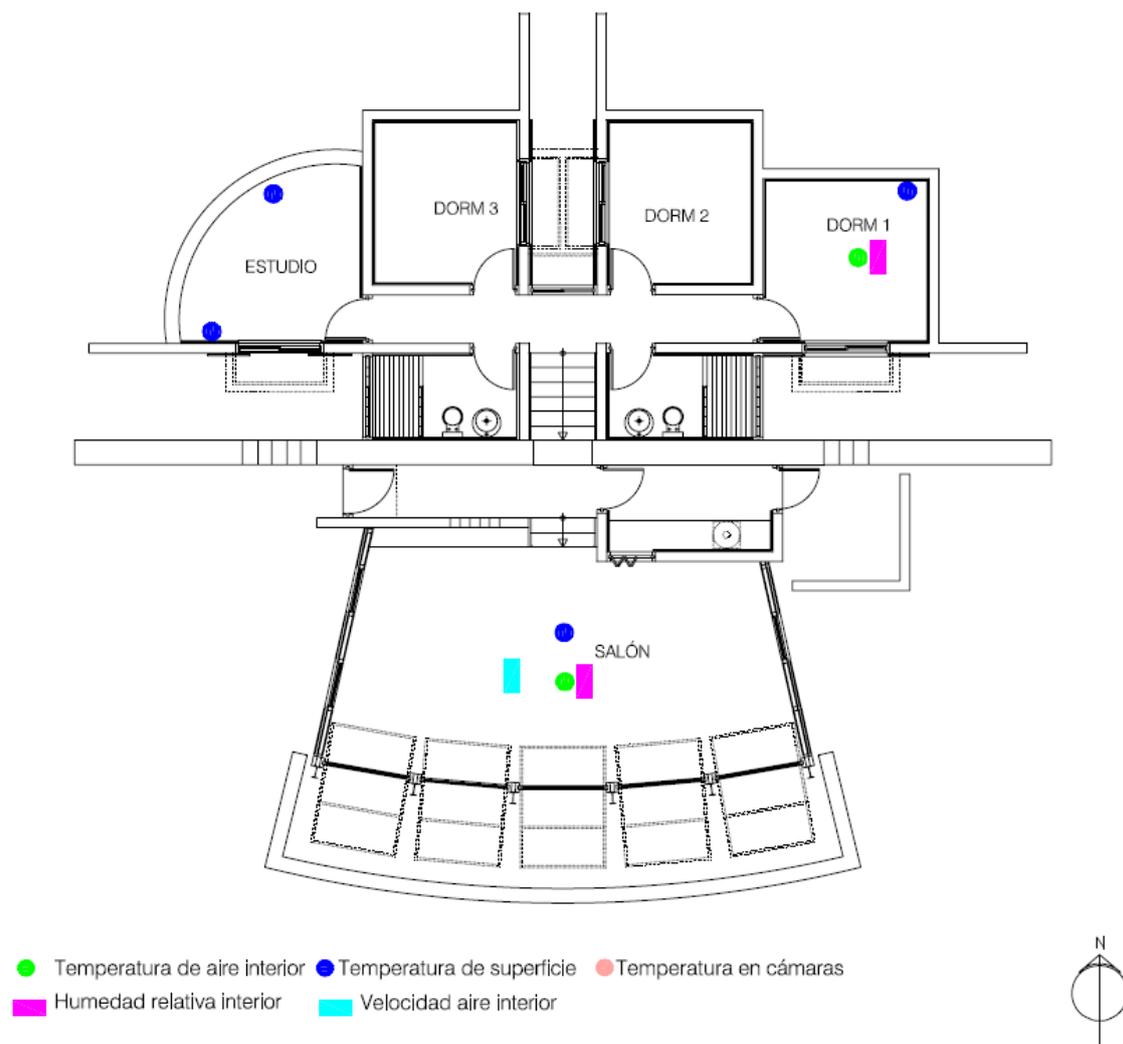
Localización de los sensores en planta baja de la vivienda 9 La Geoda
